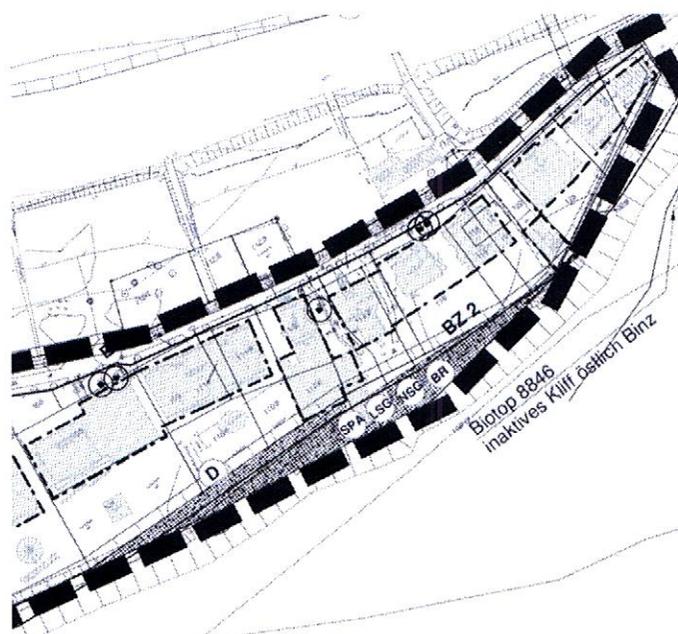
Planzeichnung Ursprungfassung, Ausschnitt unmaßstäblich
